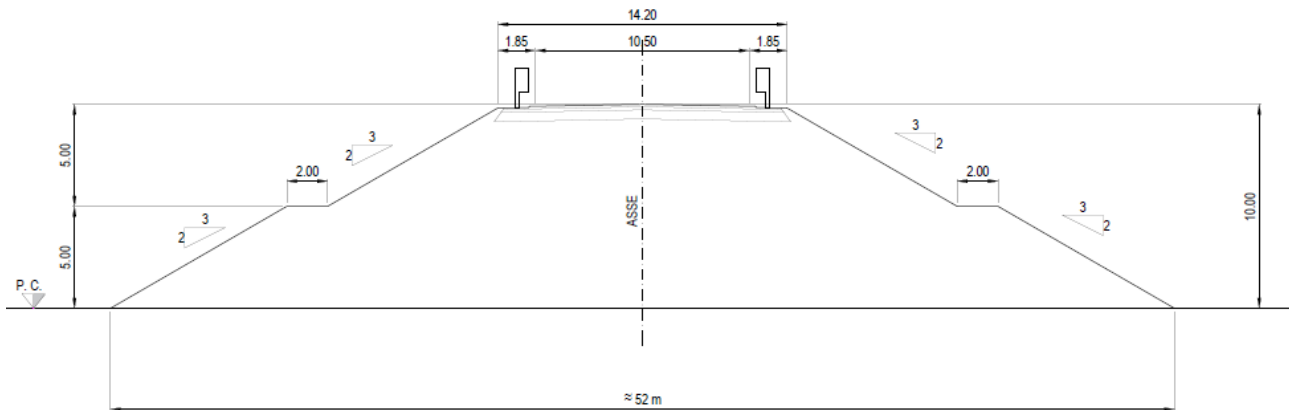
Sezione Tipo D rilevato strada categoria C1 H = 10.0 m
